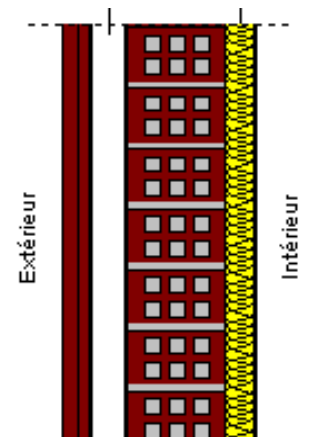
Façade ventilée avec des plaques en céramique extrudée (169)
